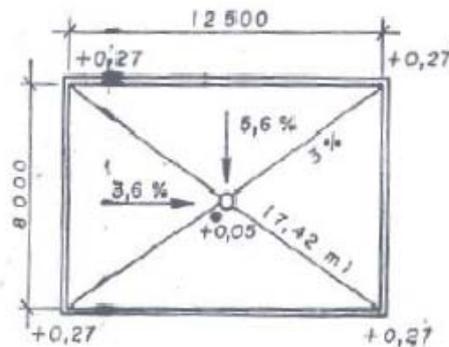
Detalle de planta contragante centrado. Fuente: Seminario de impermeabilización (Cruz, 2011).
